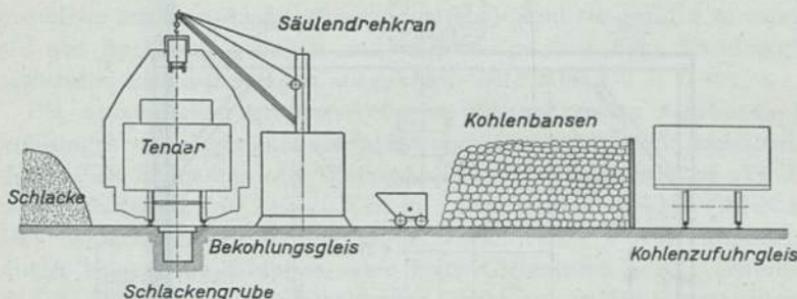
Bekohlungsanlage mit feststehendem Drehkran
